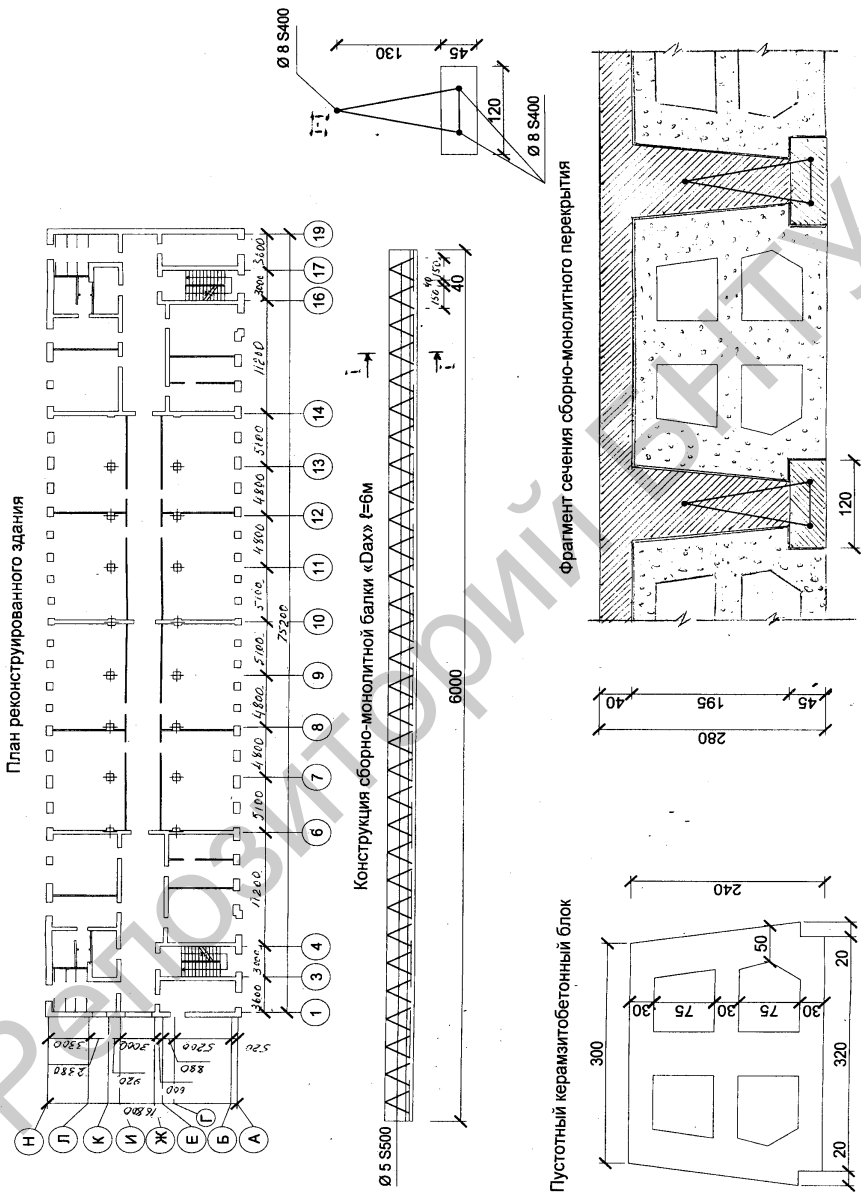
План реконструируемого здания и конструкция составляющих элементов сборно-монолитного перекрытия
